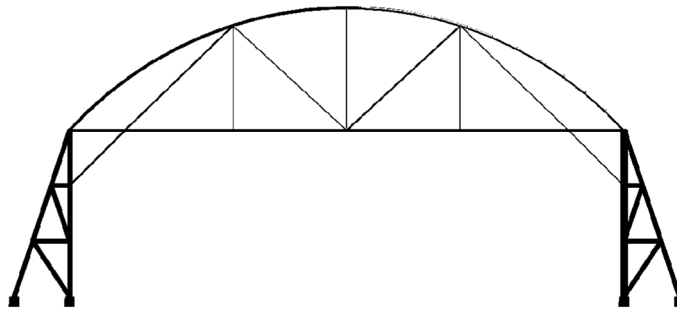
Solução alternativa adotando um contraventamento inclinado.
